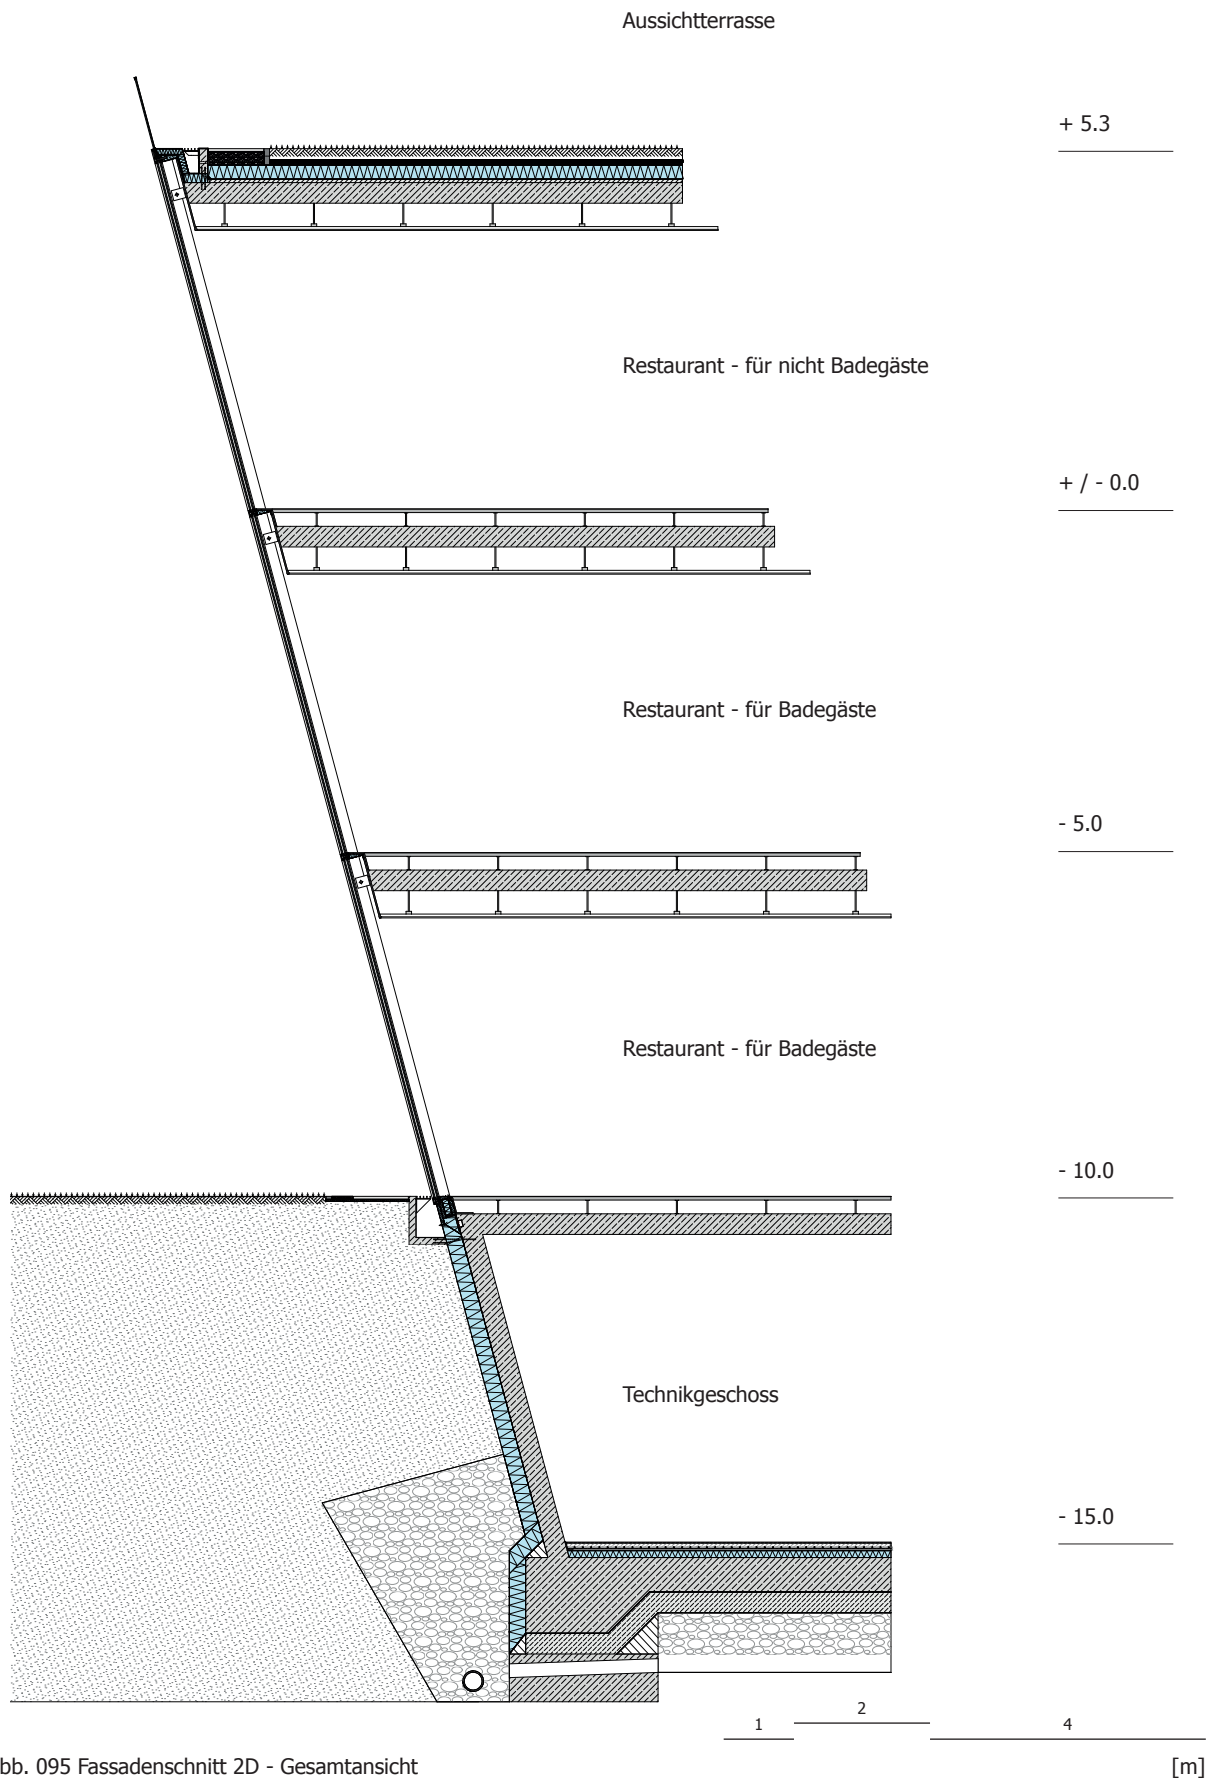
Fassadenschnitt 2D - Gesamtansicht
